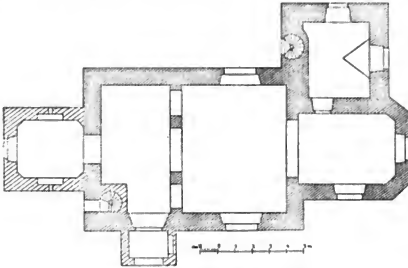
Lhota. Grundriss der Kirche.
